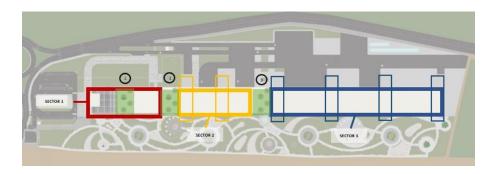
Vista de planta de sectores en el proyecto. FUENTE: Elaboración Propia
